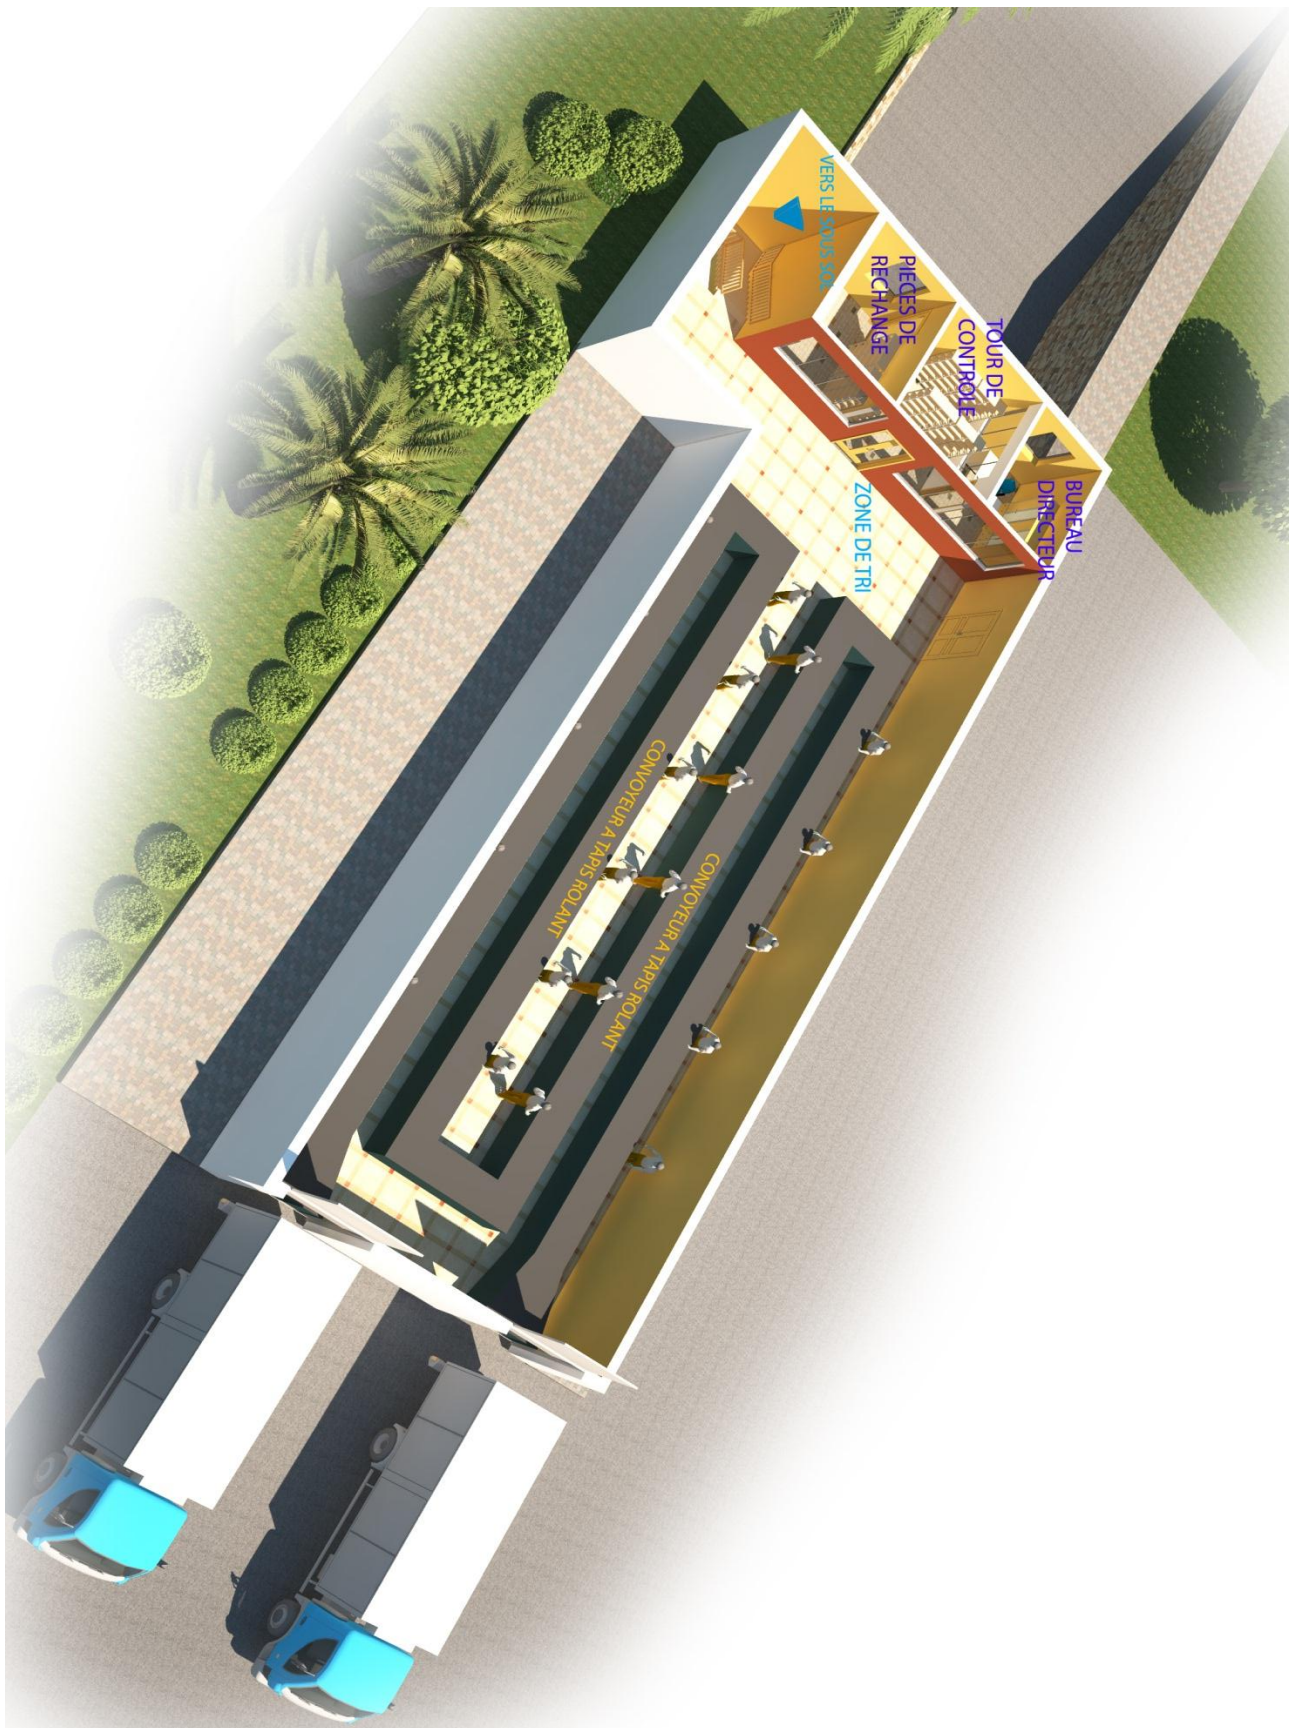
plan de notre centre de tri en 3 dimensions (1^{er} étage)
